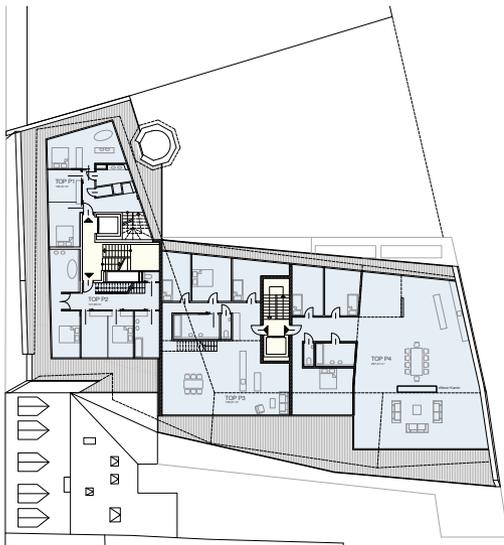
Grundrisse „Wilder Mann“, Geschoss 0-5, © LOVE architecture and urbanism
